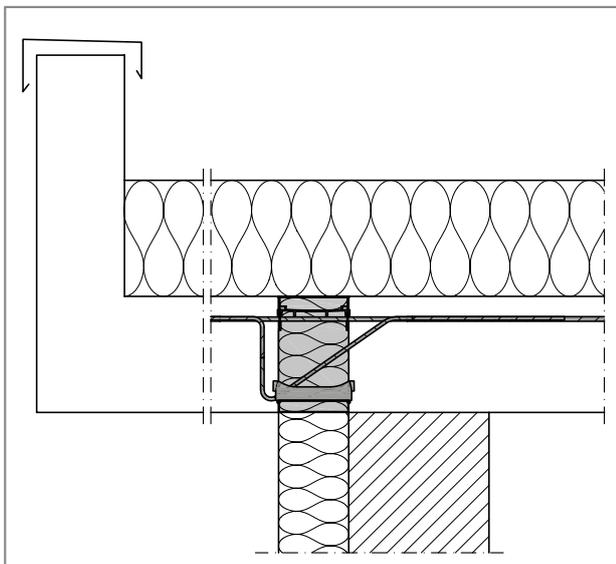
Schöck Isokorb® XT Typ K: Anschluss eines Vordachs
